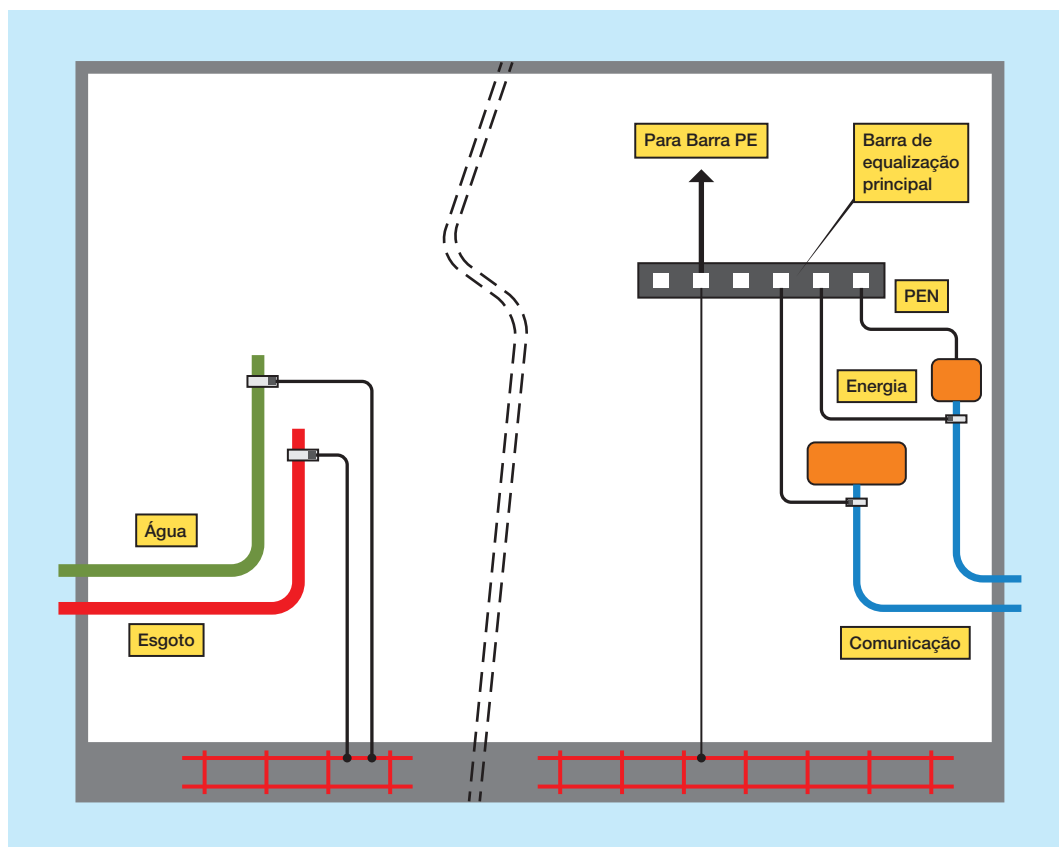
Procedimento para equalização de tubulações metálicas que adentram a edificação em local afastado da BEP. Adaptado de [3].
